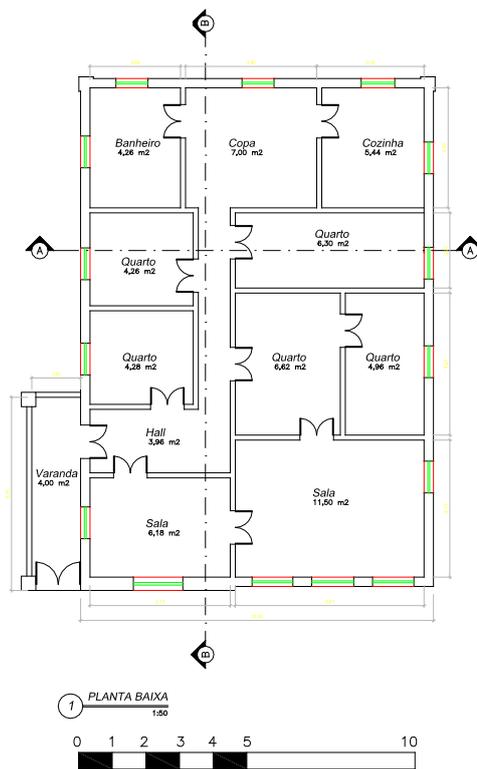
Planta Pavimento térreo - Casa Família Rodrigues (2)
